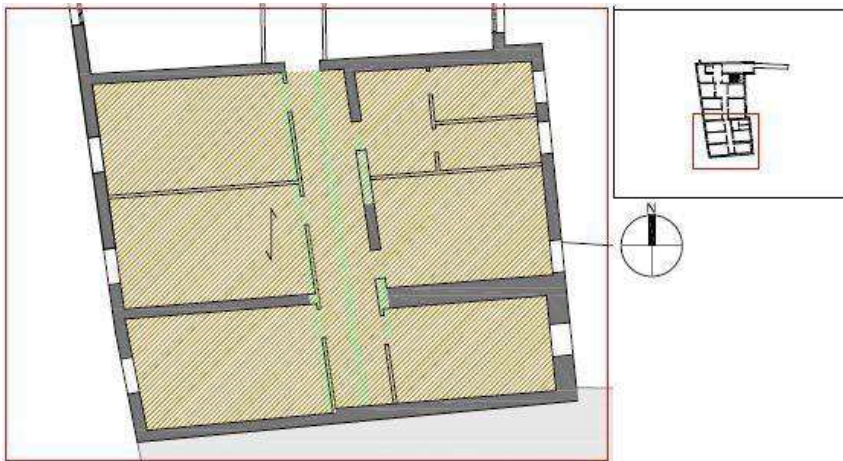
Terzo orizzontamento rilievo strutturale
